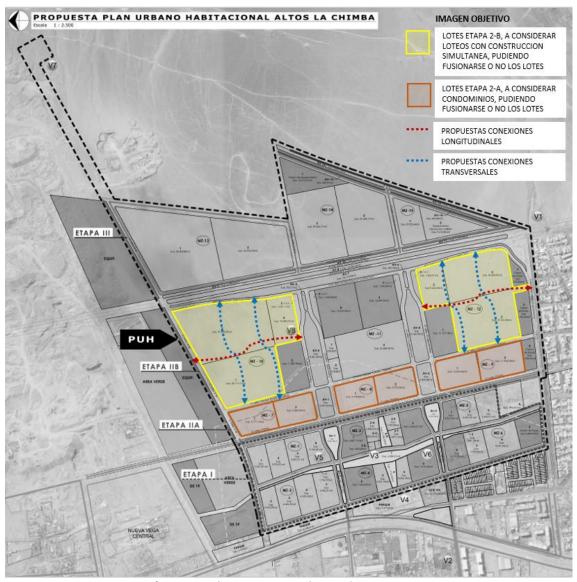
Imagen Objetivo Proyectos Habitacionales en Etapas 2-A y 2-B
